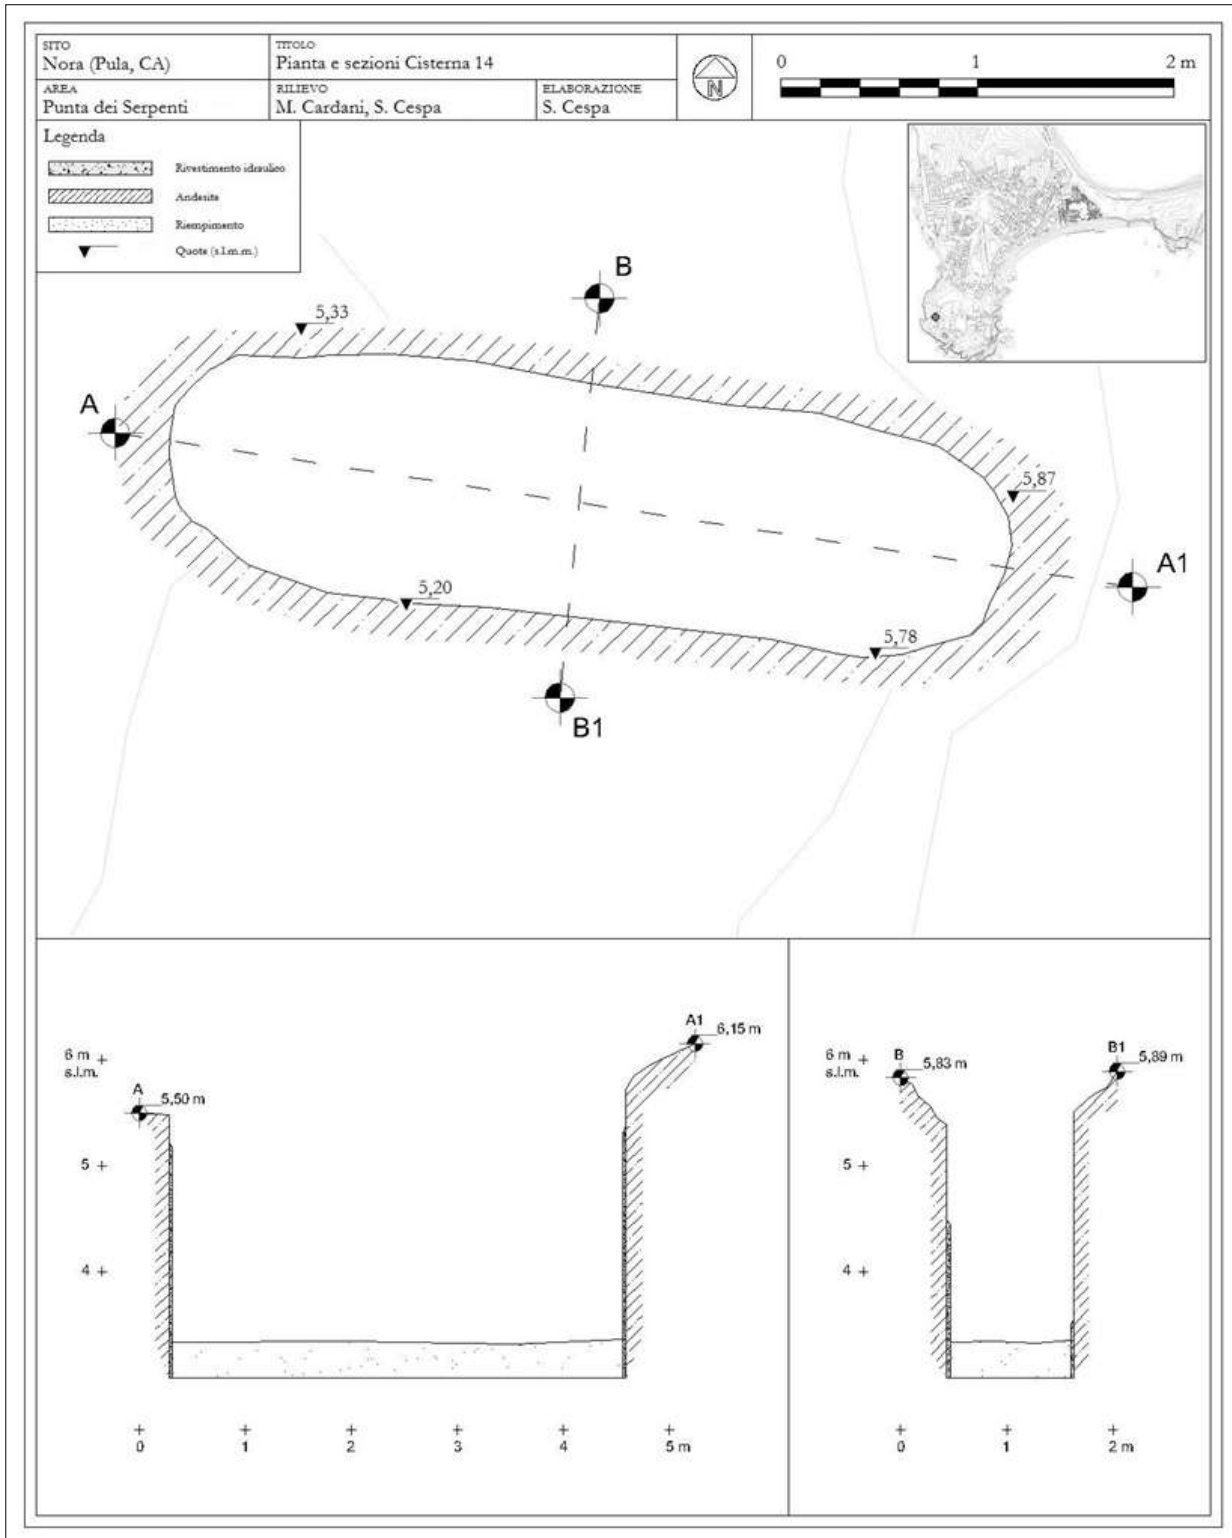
Pianta e sezioni della cisterna 14 (elaborazione dell'autore).
